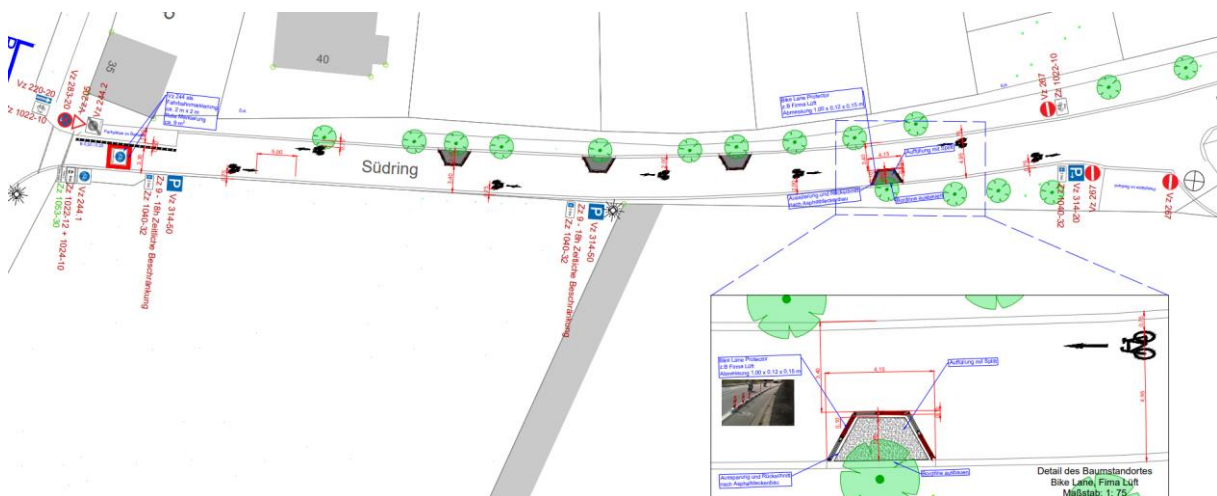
Ausschnitt Detailplanung Fahrradstraße Südring (eigene Darstellung (VAR+, 2023))
